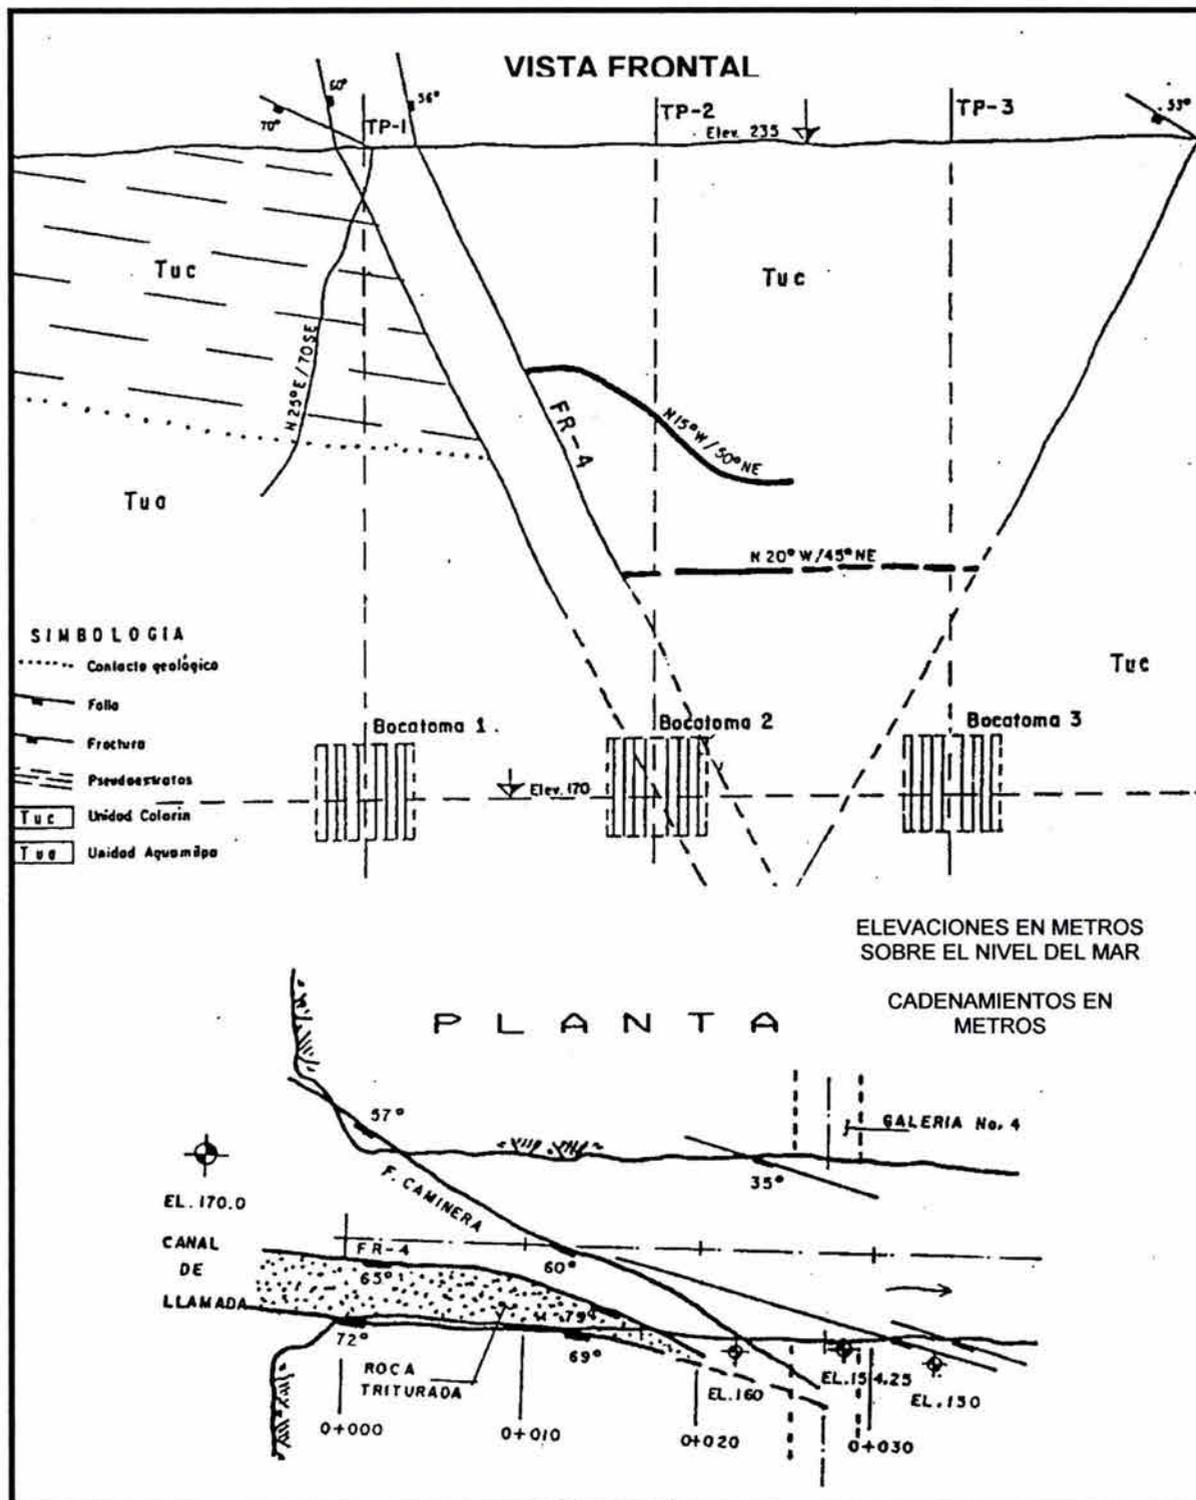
VISTA FRONTAL Y PLANTA GEOLÓGICA
